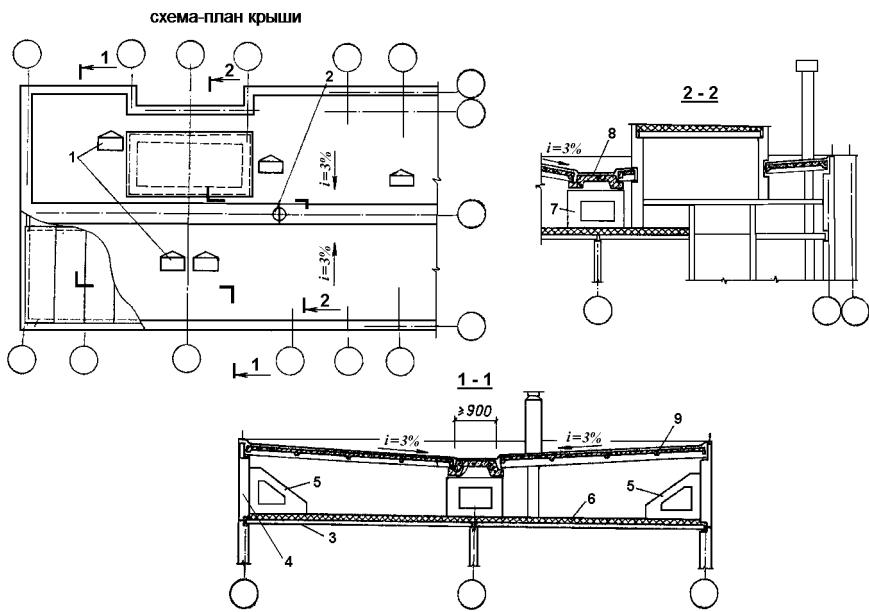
Конструкция чердачной крыши с холодным чердаком и кровлей из рулонных интервалов.
